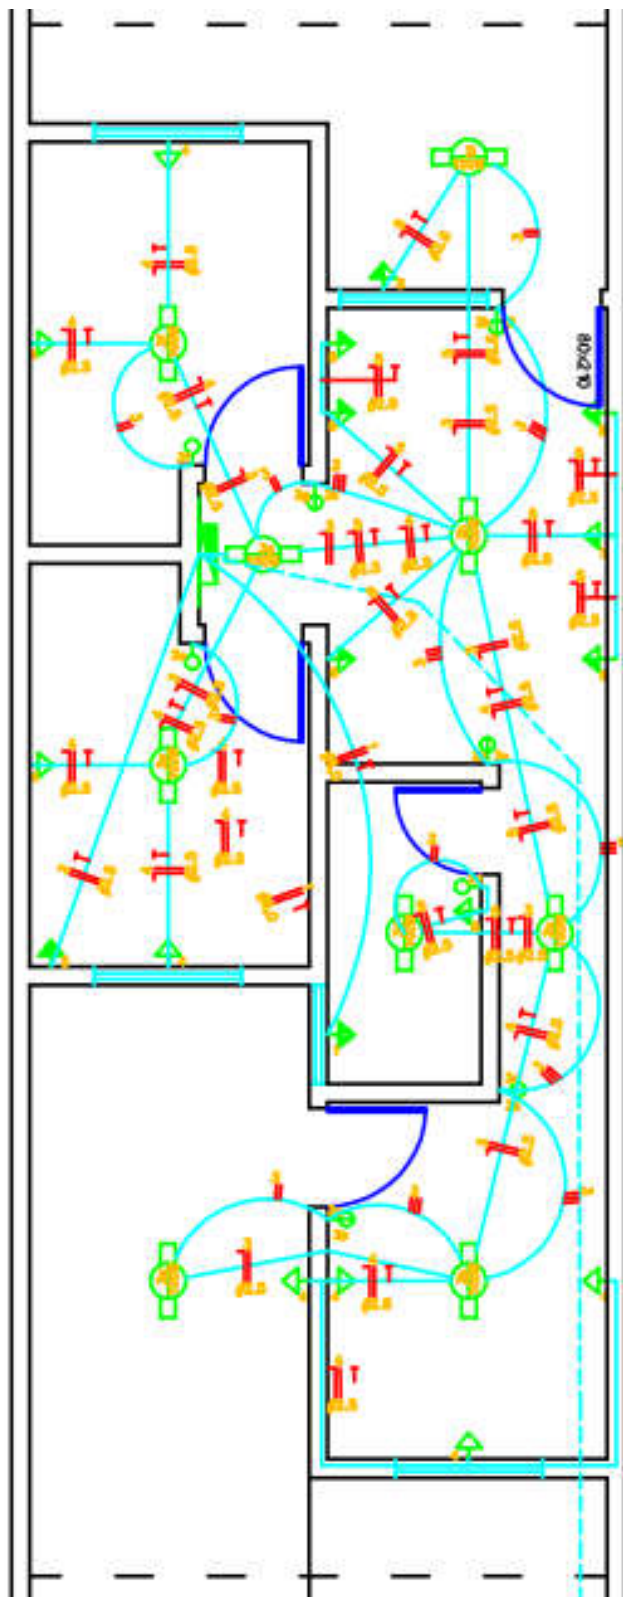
Projeto elétrico da construção convencional. Fonte: o autor (2016).
